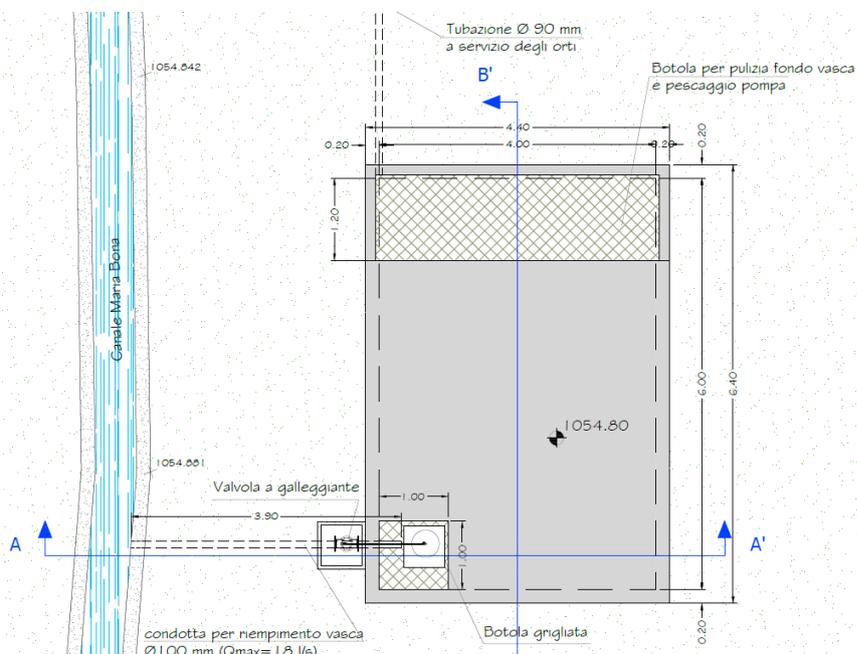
Estratto Tavola 7 del progetto irriguo – pianta vasca in località Pian delle Rovine
